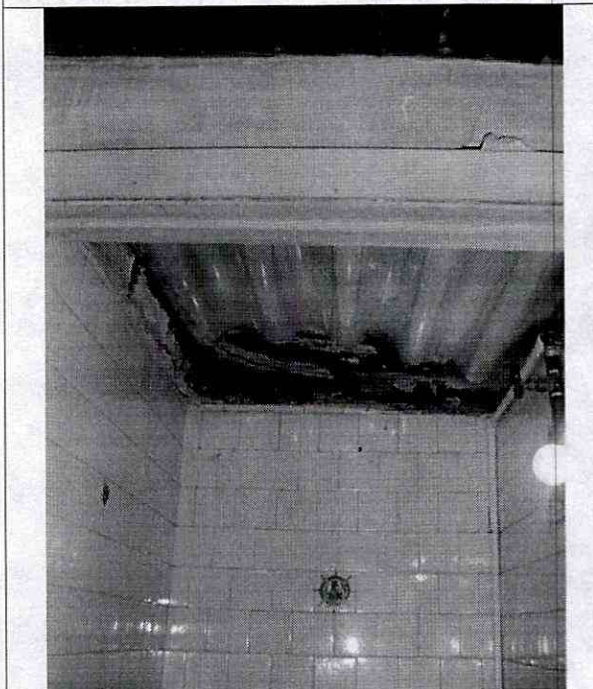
Sector en el que fue reemplazada la placa de concreto original por láminas acrílicas.
